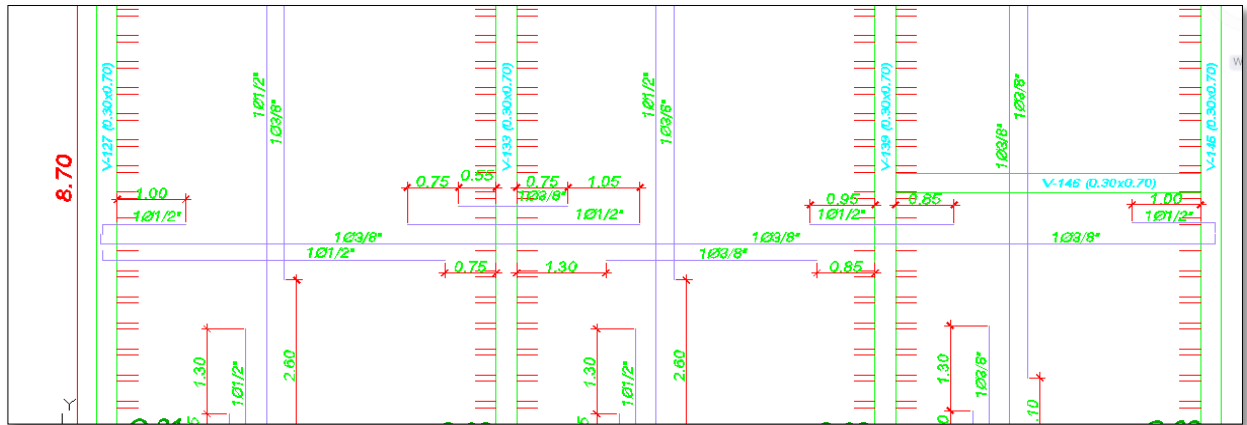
Armadura de losa aligerada en la Dirección X-X
